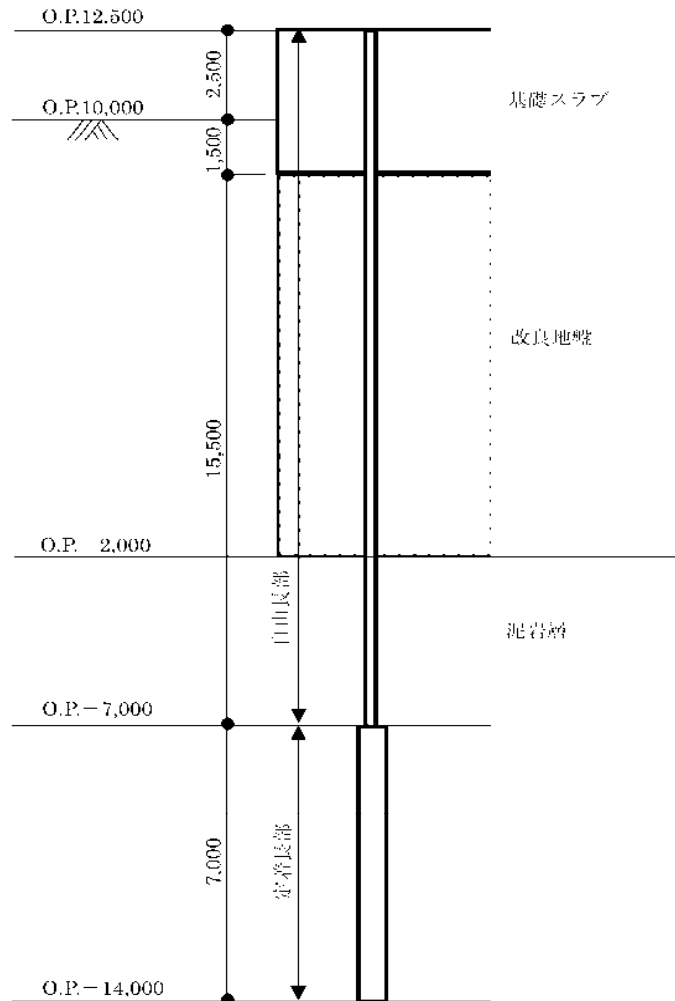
地盤アンカー設置計画 (単位: mm)
